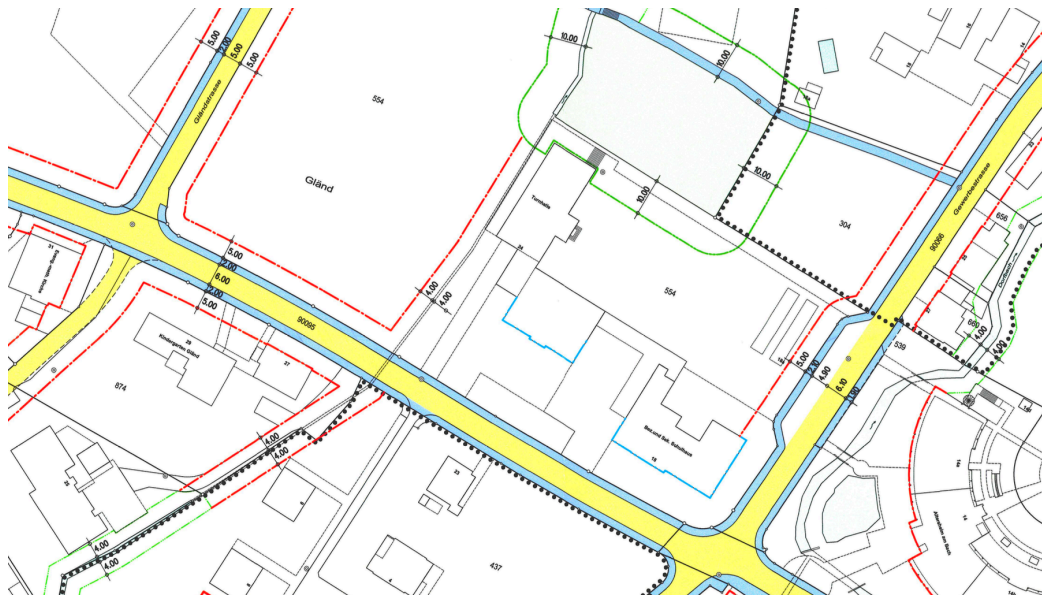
Ausschnitt Erschliessungsplan, RRB 2005
